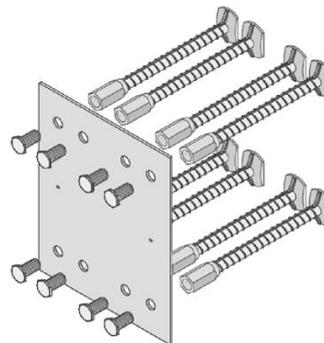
HSC-B Muffenstäbe mit Einbauschablone mittels Flachkopfschrauben (Befestigungszubehör) verschrauben
